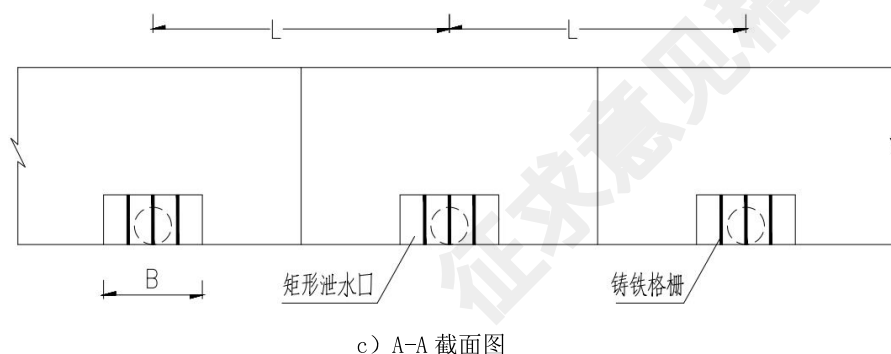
混凝土护栏矩形泄水口示意图
